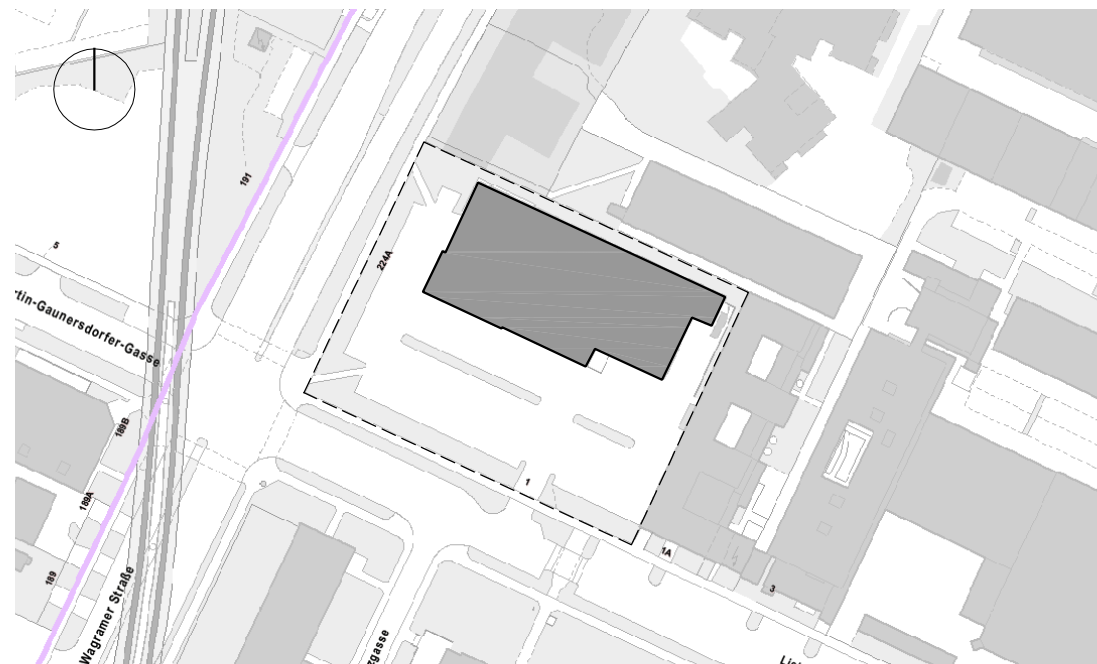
Lageplan Lieblgasse M 1:2000⁴⁷
